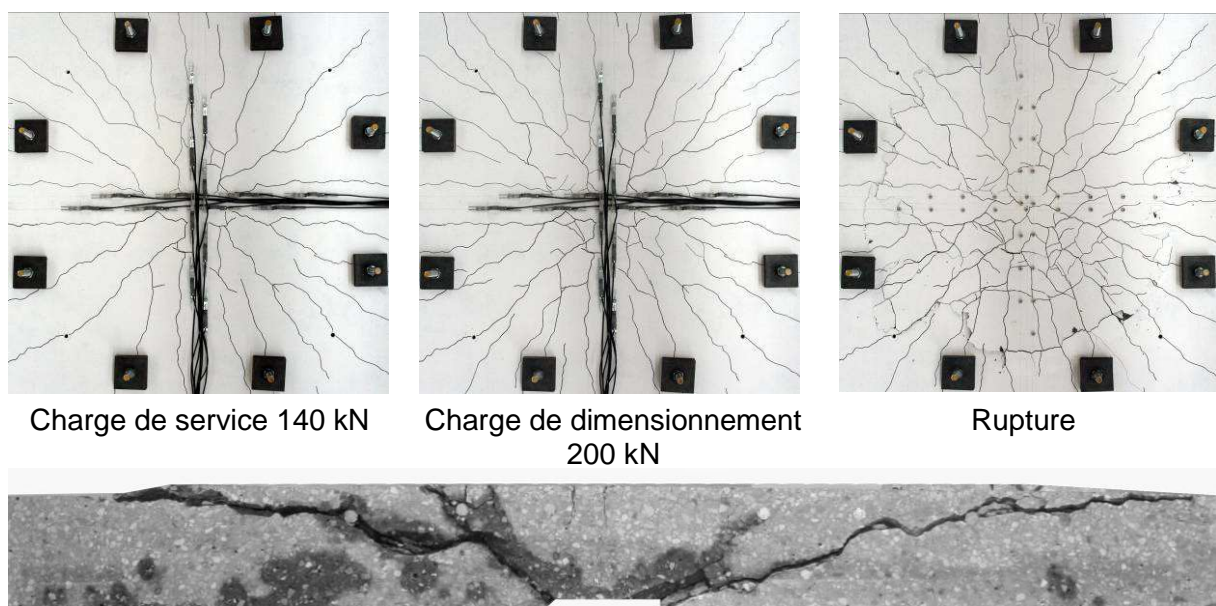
Fissuration à plusieurs niveaux de charge et fissures internes de la dalle B1-06.
